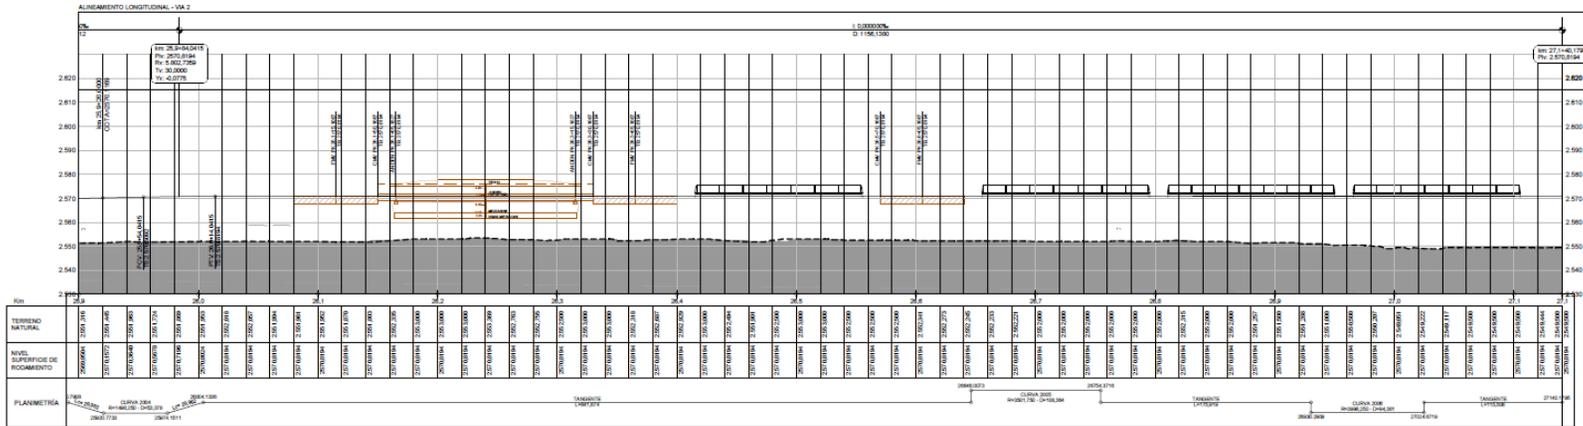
Perfil longitudinal del trazado extensión PLMB-Tramo1, Tramo calle 100 Norte – Via 2
